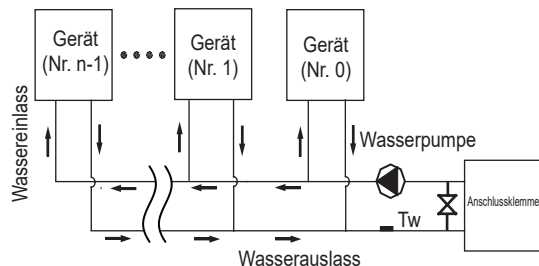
Installation einer einzelnen Wasserpumpe
